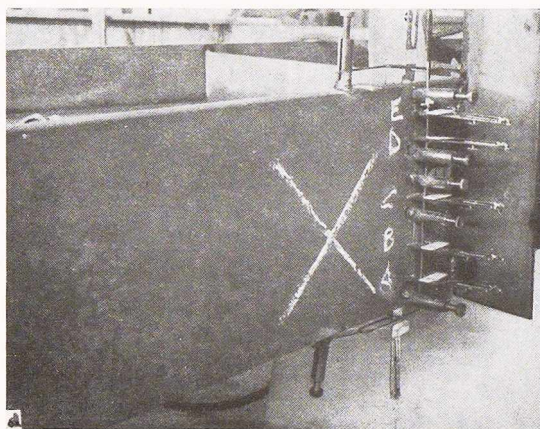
Extensomètres Huggenberger montés sur la poutre d'essai.
